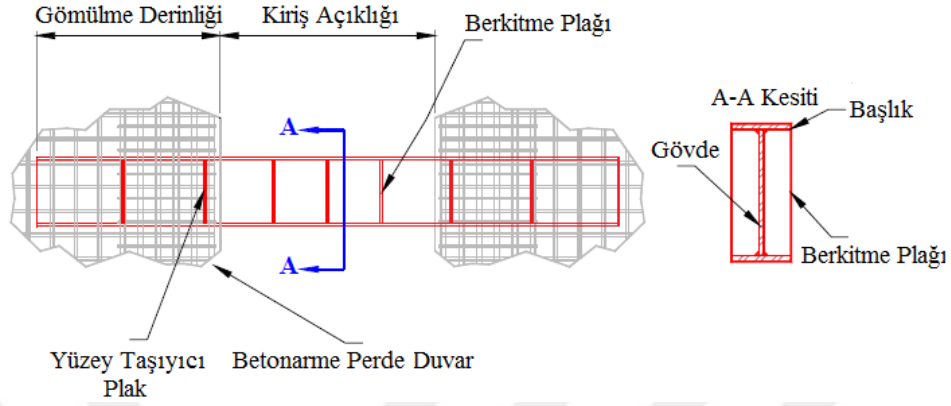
Çelik plakla güçlendirilmiş beton kirişi (Fortney, 2005)
